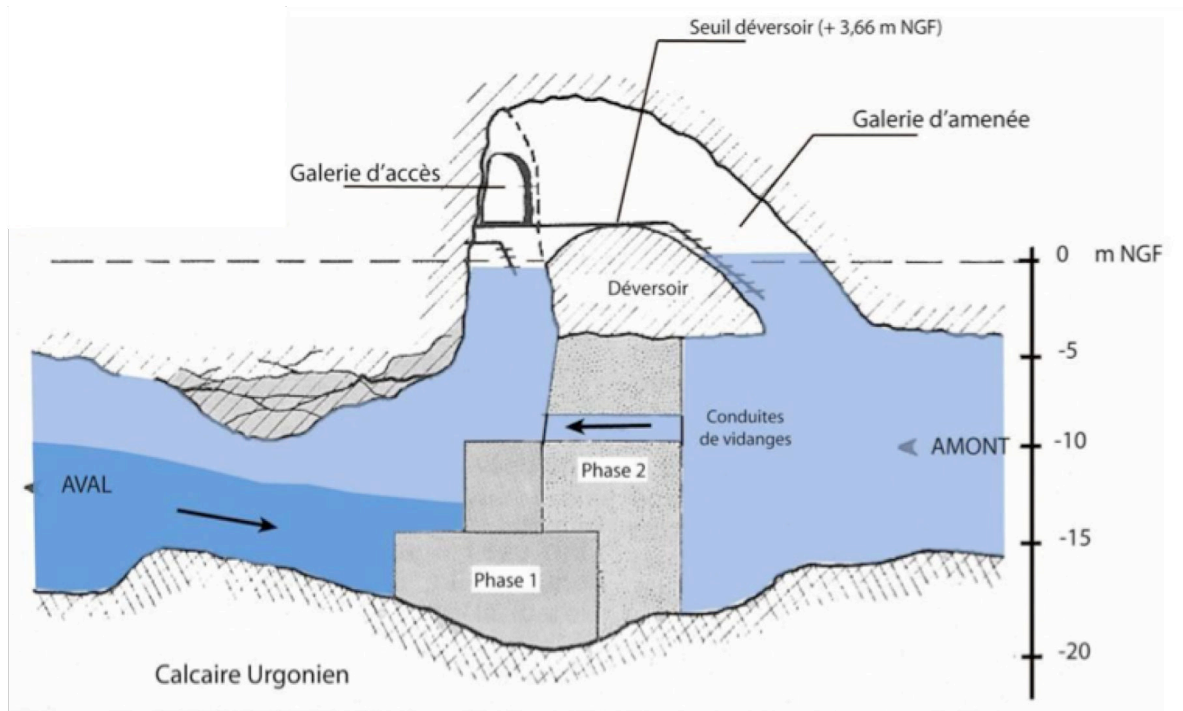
Schéma en coupe du barrage de Port-Miou obstruant partiellement la galerie naturelle (Cavalera, 2007).
